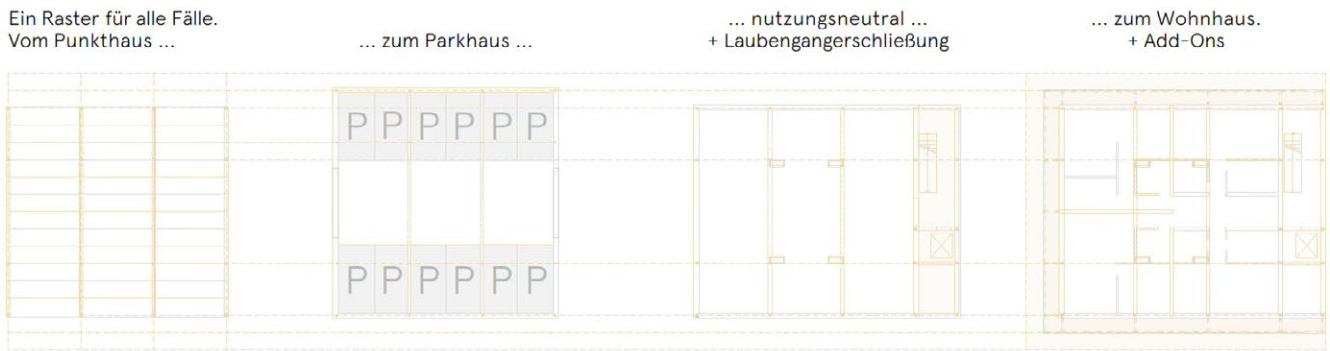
Flexible Tragwerks- und Grundrissgestaltung am Beispiel „Am Horn“ in Konstanz
